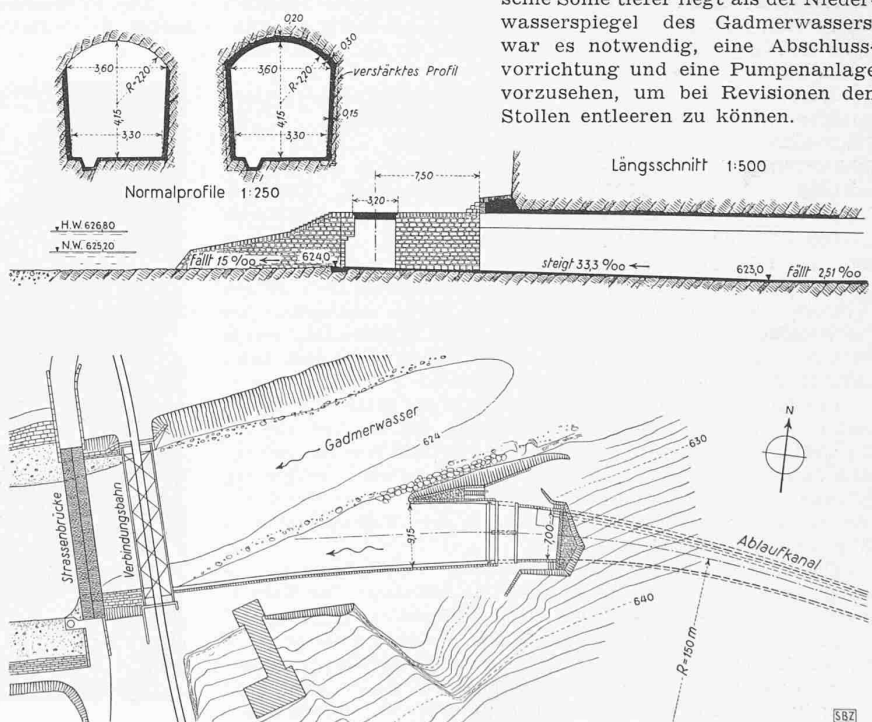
Oben: Unterwasserstollen-Profile, darunter Auslauf Schnitt 1:500 u. Lageplan 1:1000
